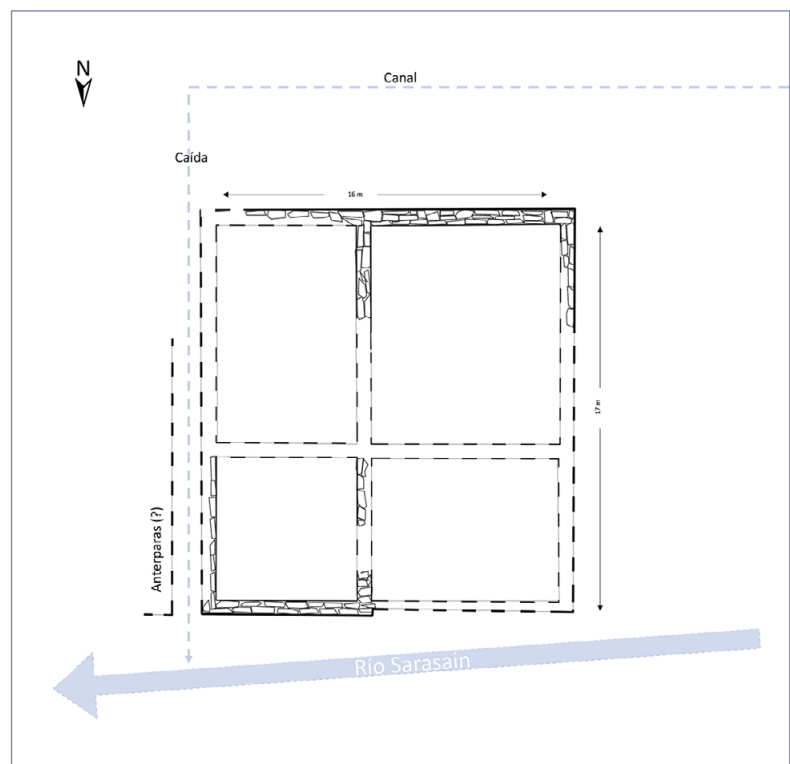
Dibujo de planta y posible interpretación de la ferrería de Sarasain. Escala 1:125. Fuente: elaboración propia.
